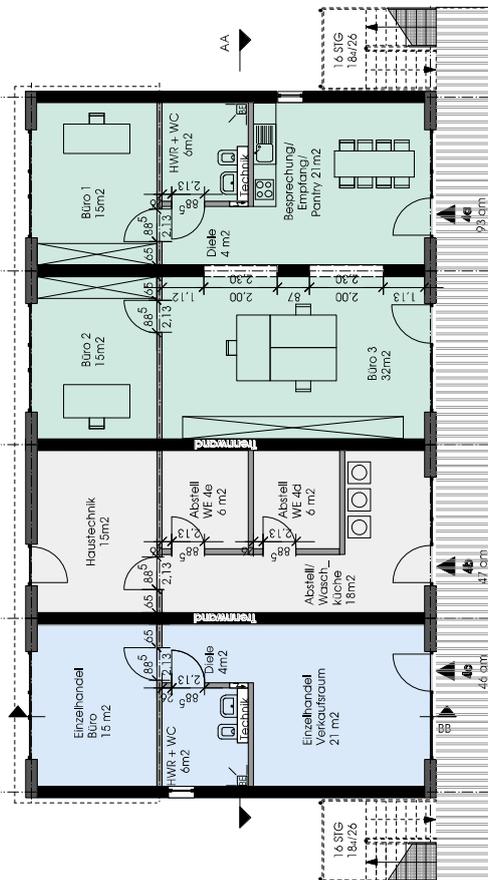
GUTZEIT (2017): Grundriss Erdgeschoss
